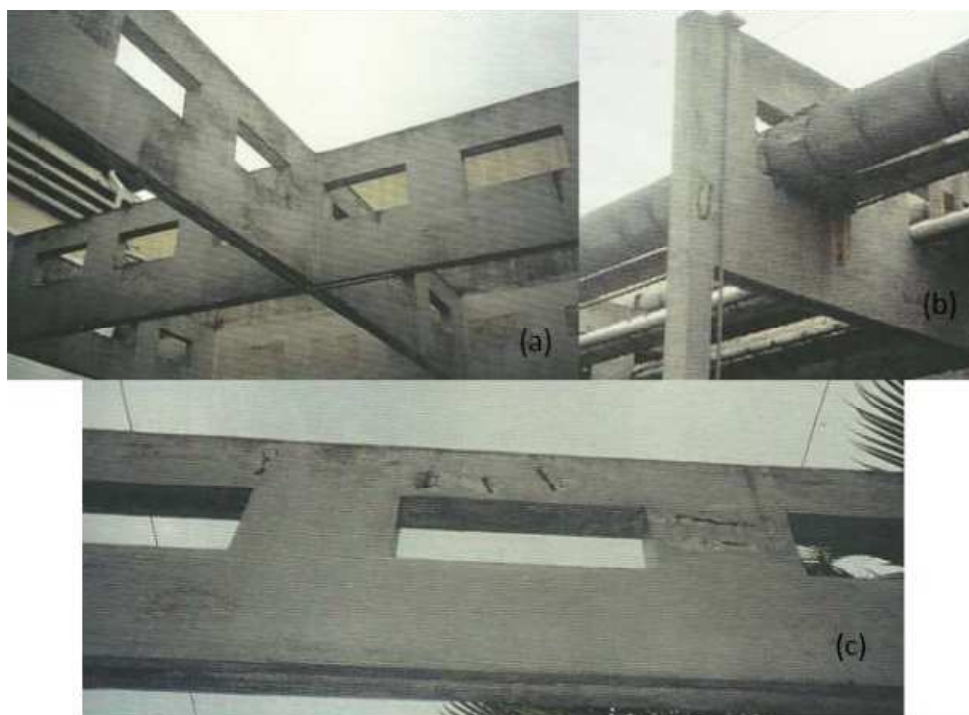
Vigas Vierendeel em 2000 - (a) infiltração e fungos, (b) e (c) destacamento do concreto e armadura exposta.
